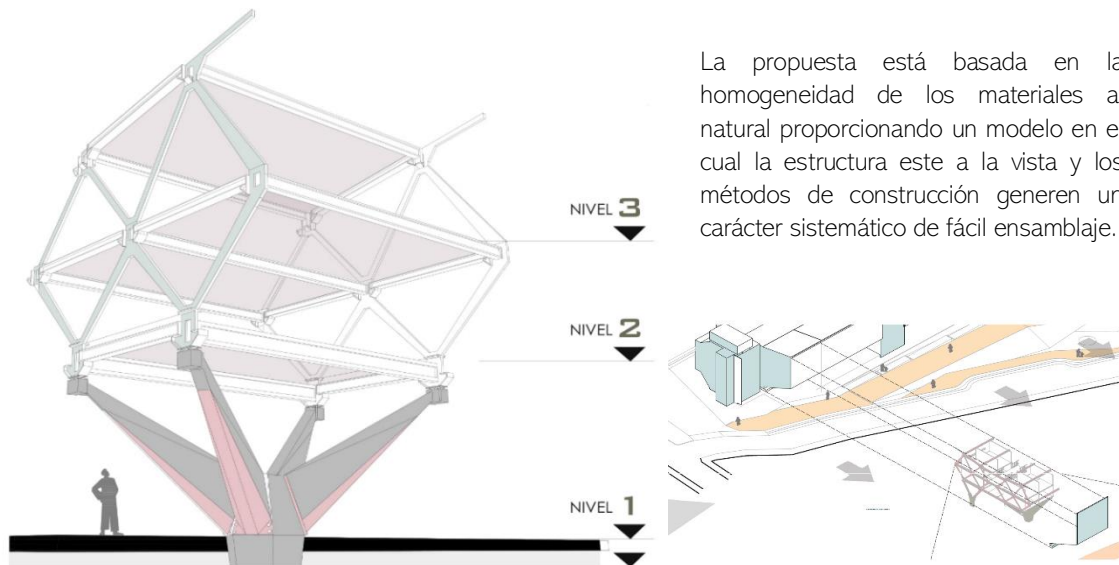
Esquema modulo de estructura mixta (red metalica – base en concreto reforzado).
